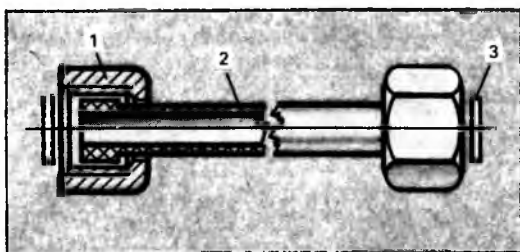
Гибкая подводка к пластмассовым и стальным трубам с резьбой 1/2В: 1 — накидная гайка, 2 — полиэтиленовая трубка, 3 — резиновая прокладка
